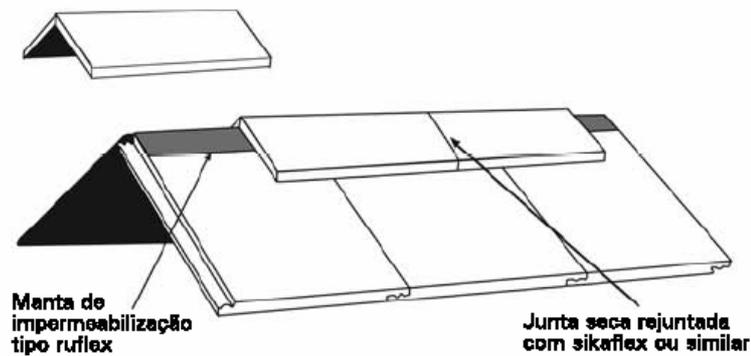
Detalhe cumeeira - telhas de concreto tipo plana. Fonte: TÉGULA, 2006.
